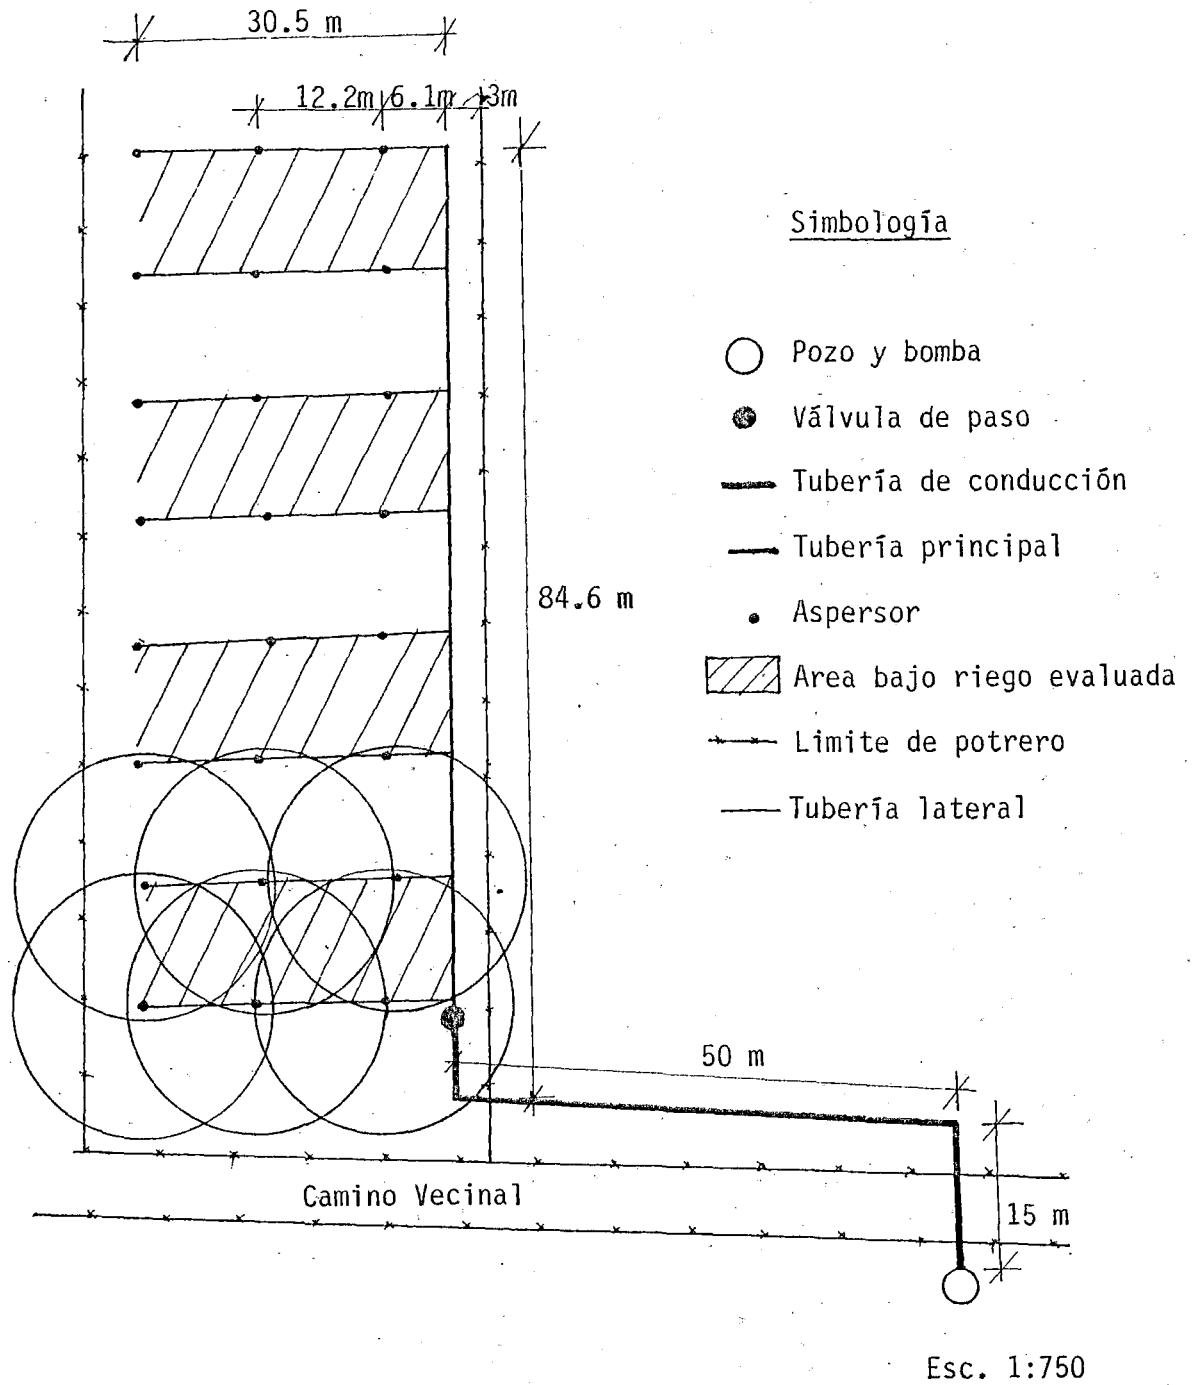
Plano de distribución de tubería y área bajo riego evaluada.
